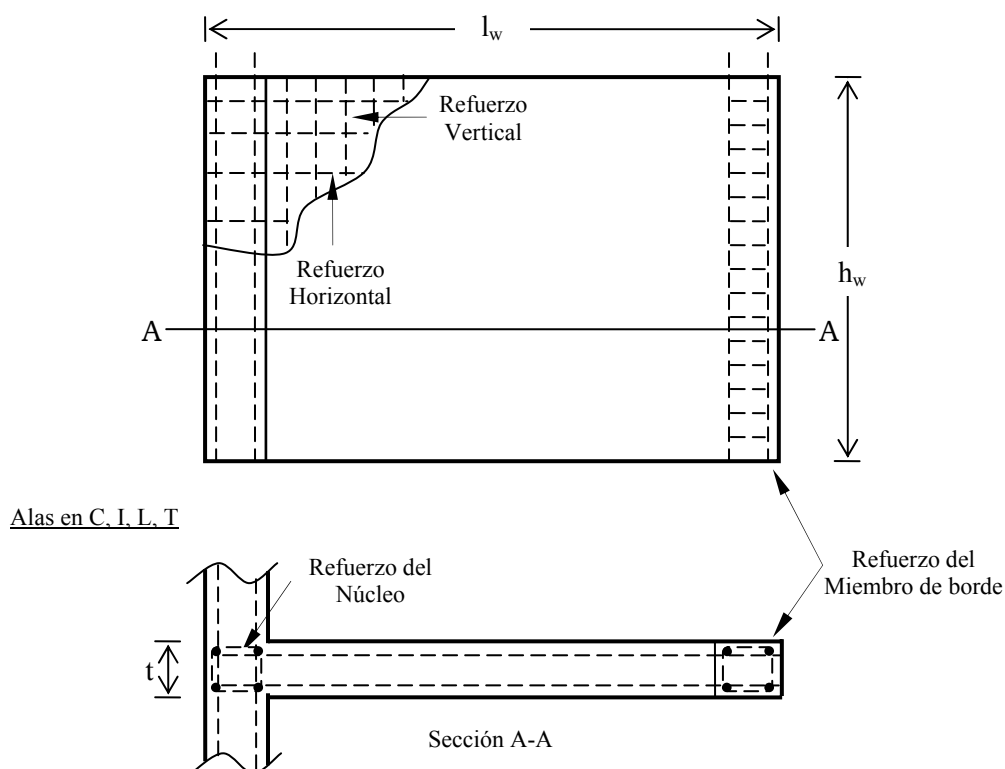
Distribución del Refuerzo en Muros Estructurales.
